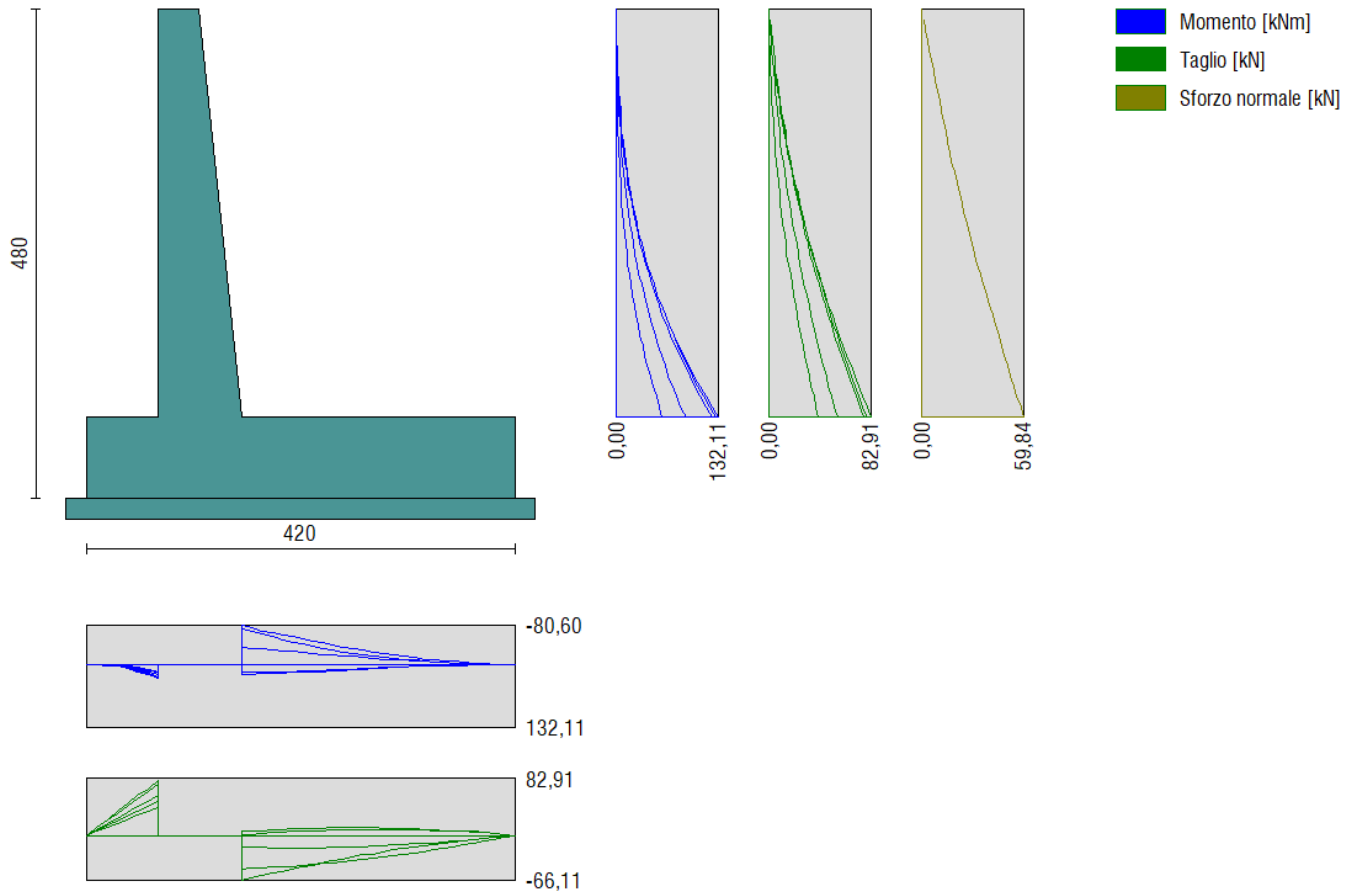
Involuppo delle sollecitazioni sul paramento e sulla piastra di fondazione del muro di sostegno
